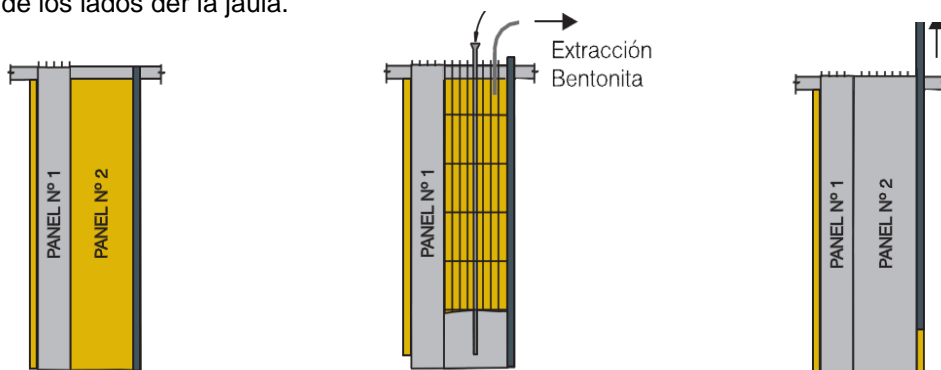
Colocación de tubo-junta Colocación de armadura y hormigonado Extracción tubo-junta
